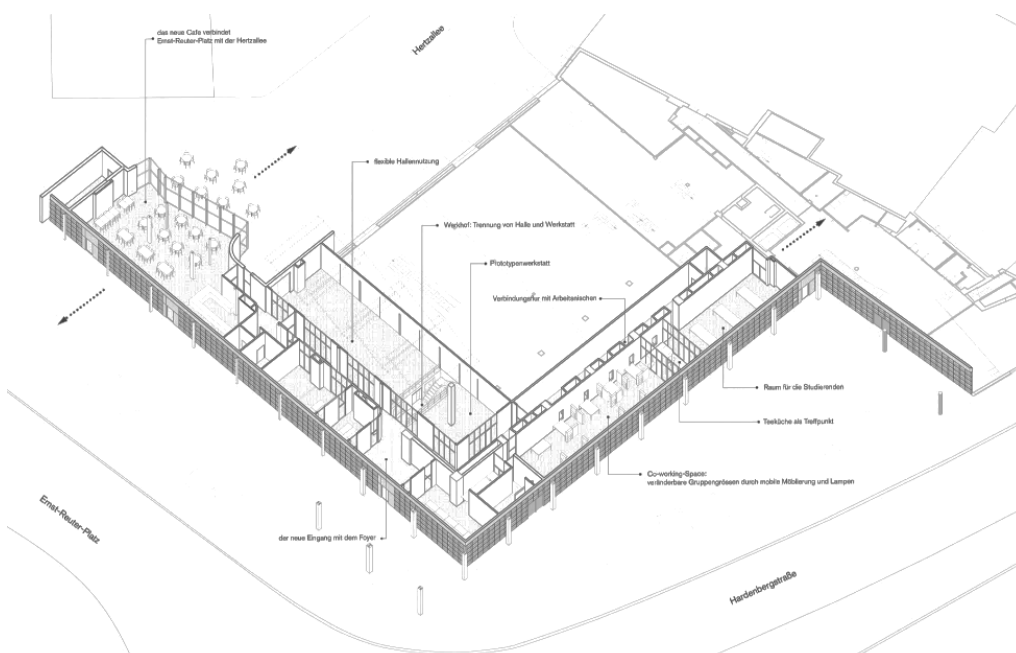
Coworking Space EINS, Isometrie der Erdgeschosszone des Willi-Kreuer-Baus [Sanierungs- und Umbauplanung, Plangrafik: fatkoehl architekten]
